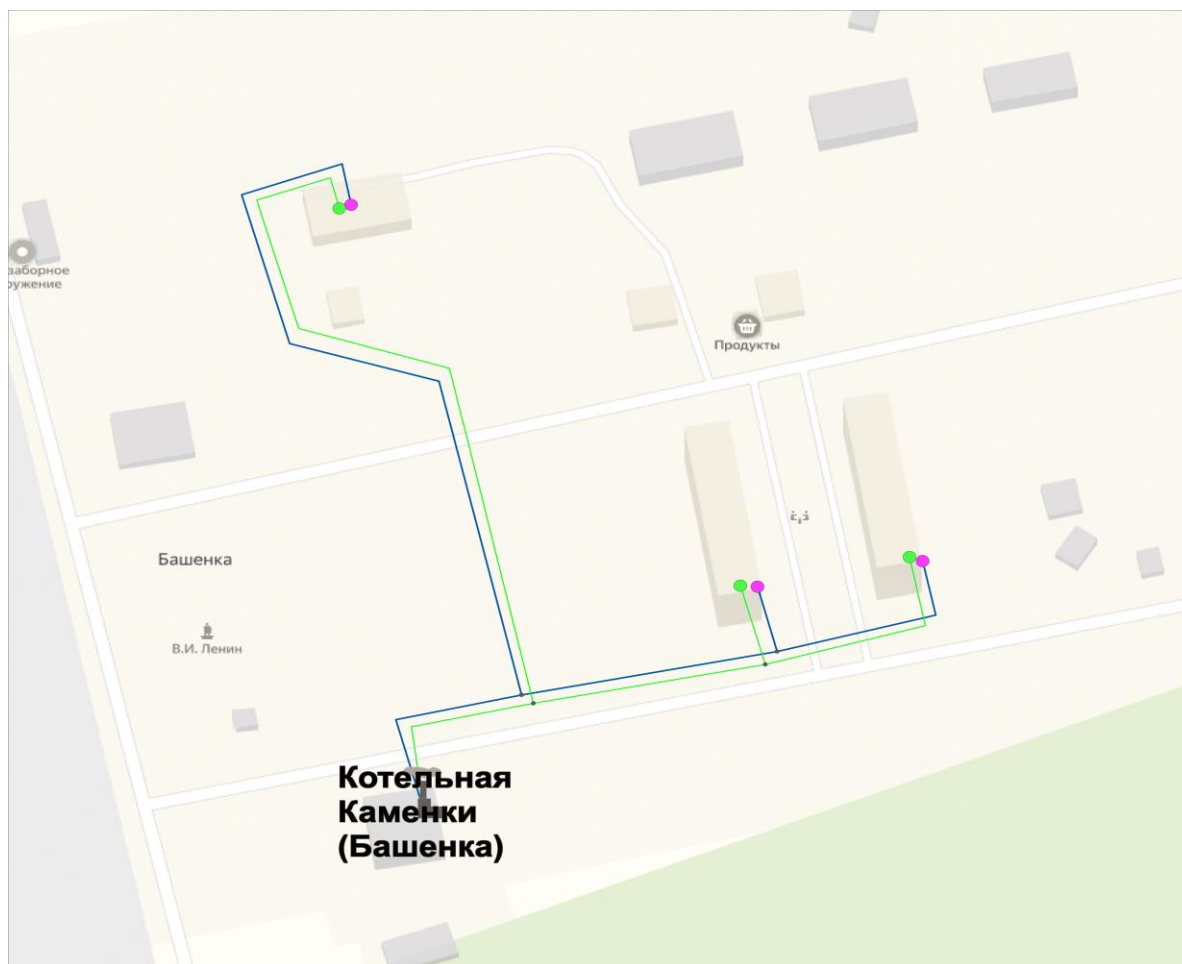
Схемы тепловых сетей от Котельная Каменки (Башенка)
